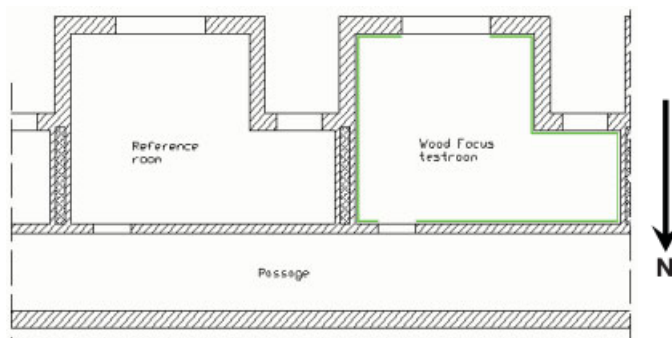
Grundriss und Lage der beiden Versuchsräume im Gebäude [7]
